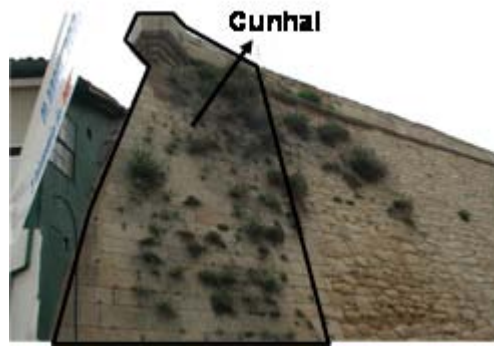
Cunhal de ligação dos panos SE e SO da muralha
